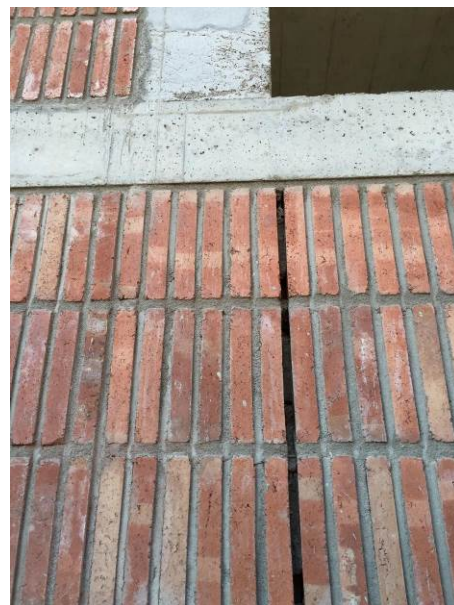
Vista de bigues de cantell de Planta Baixa al volum B
